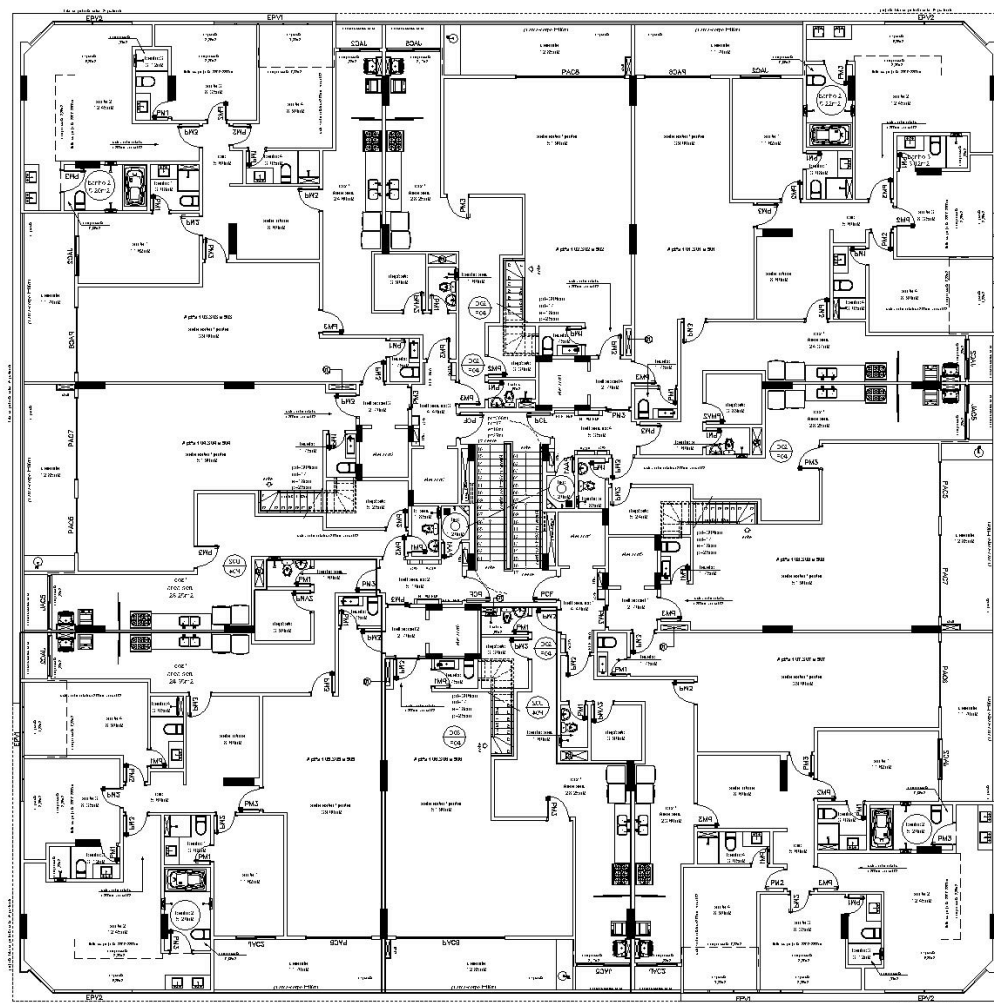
planta baixa do pavimento tipo do edifício multifamiliar 01 (fonte: arquivo pessoal)
